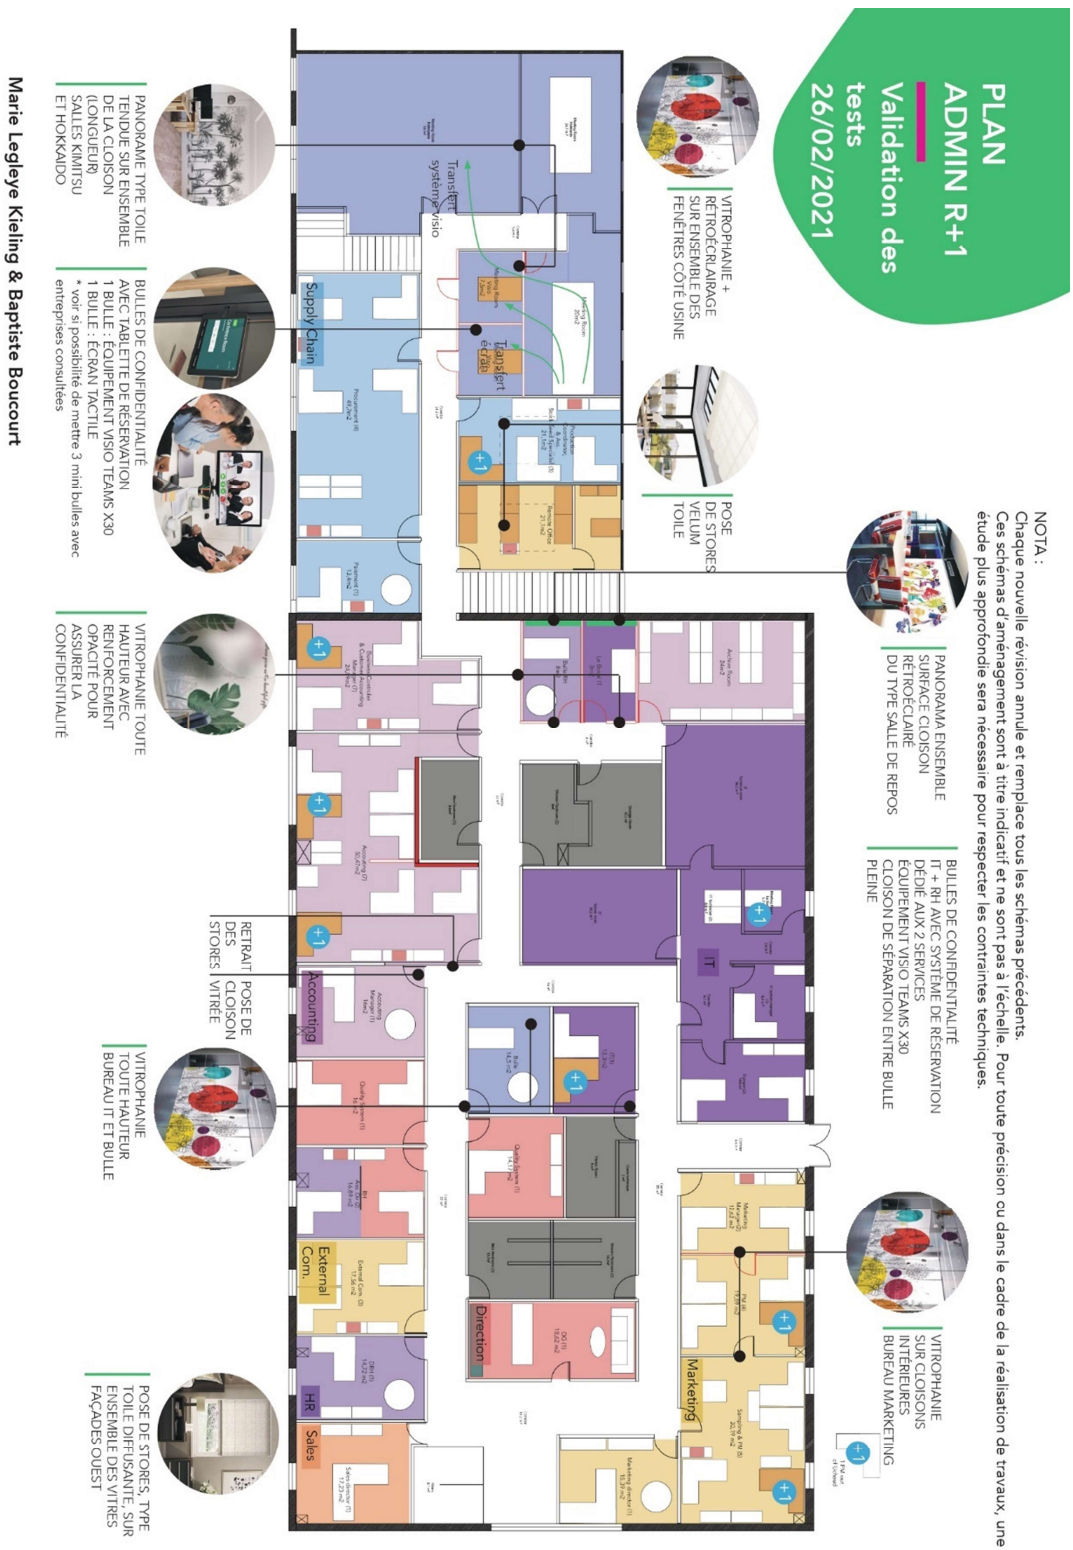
Exemple de plan de tests coconstruit avec le groupe de travail
